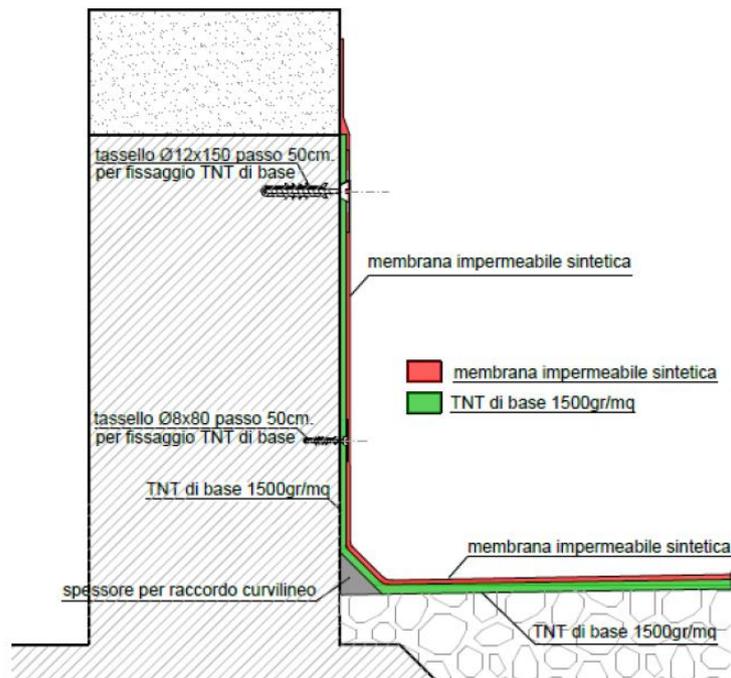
Posa dell'impermeabilizzazione: Particolare della posa sui piani verticali
